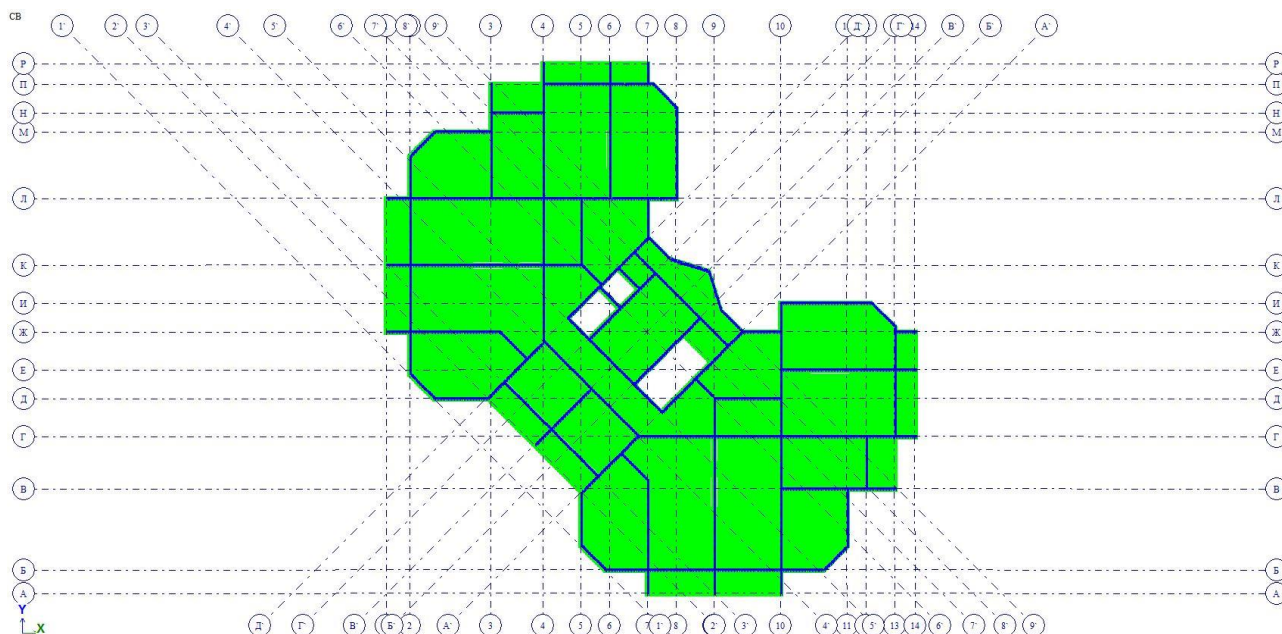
Расчетная схема типовой плиты перекрытия
